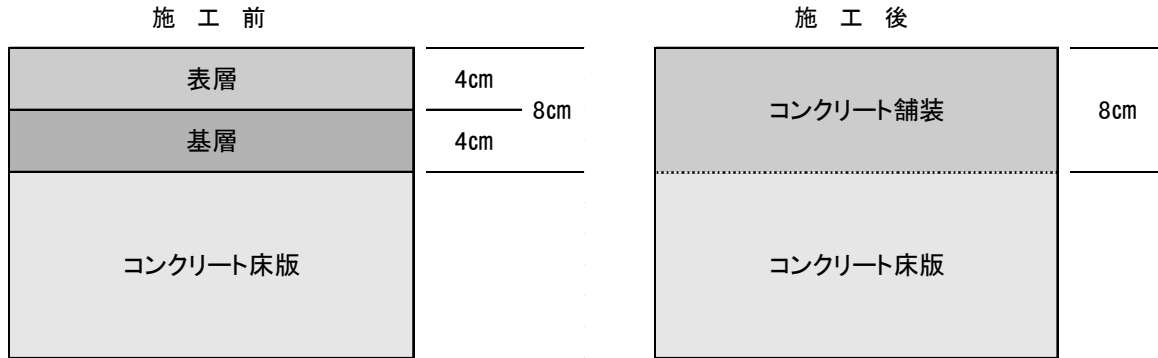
橋面コンクリート舗装の工事費試算用施工断面
